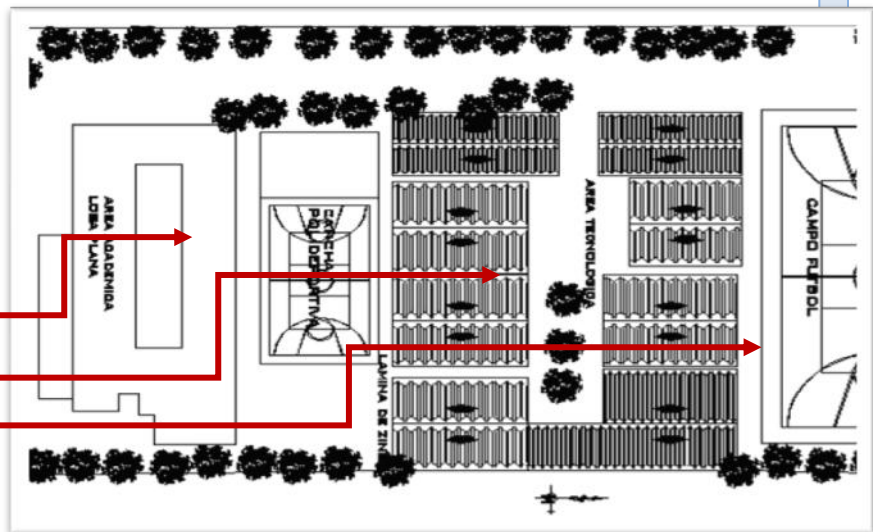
Planta de Conjunto Instituto Tecnico Industrial
